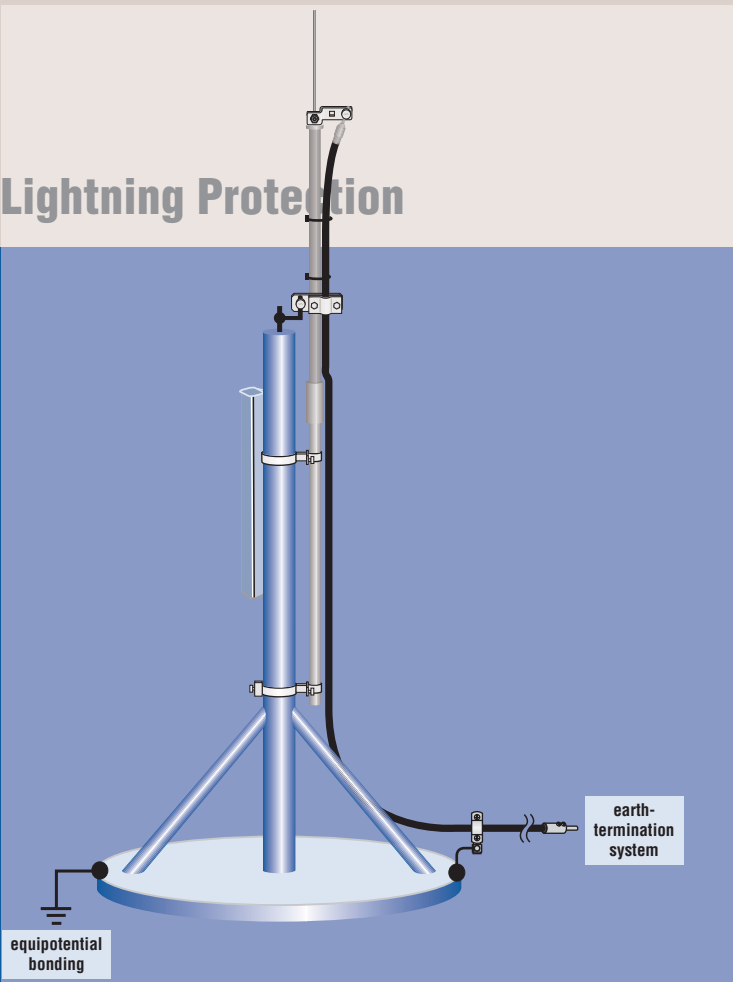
Getrennte Fangeinrichtung mit HVI-Leitung I an Dachaufbau
